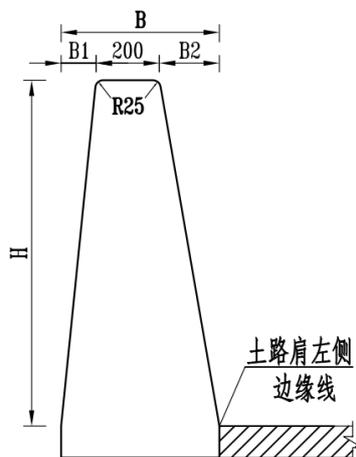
单坡型玻璃纤维钢筋混凝土护栏 (尺寸单位: mm)
